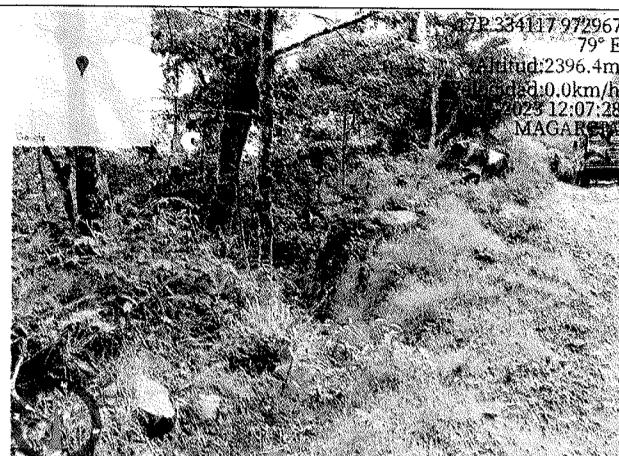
Drenaje pluvial. Fuente: MGarcía.
